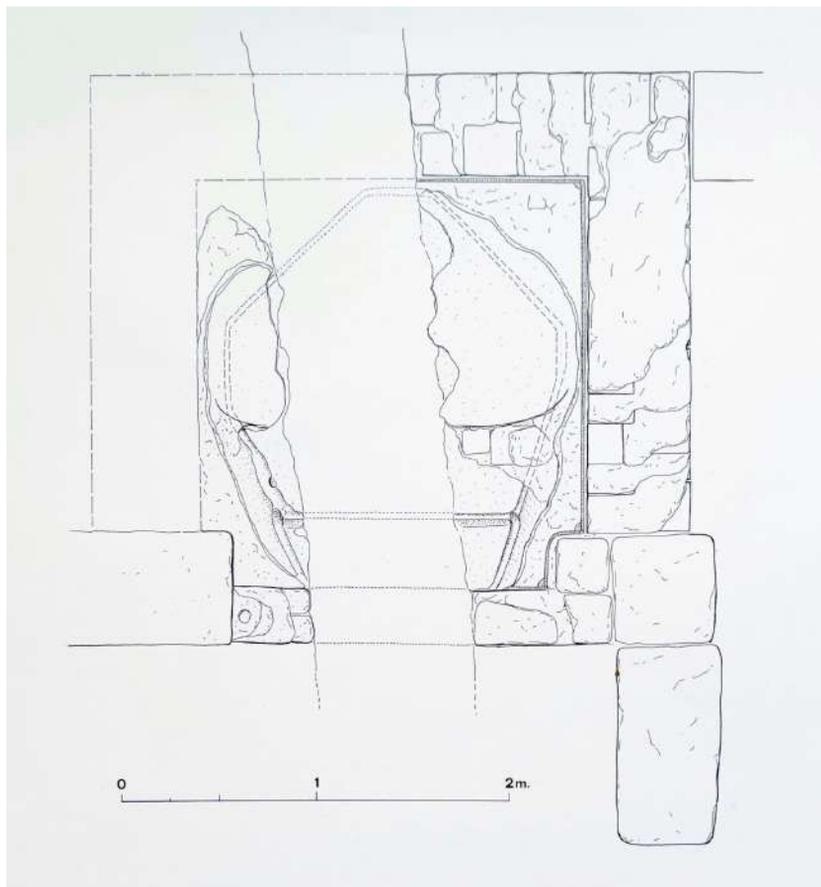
Planta del sector de la piscina (Dib. M. Bendala).
